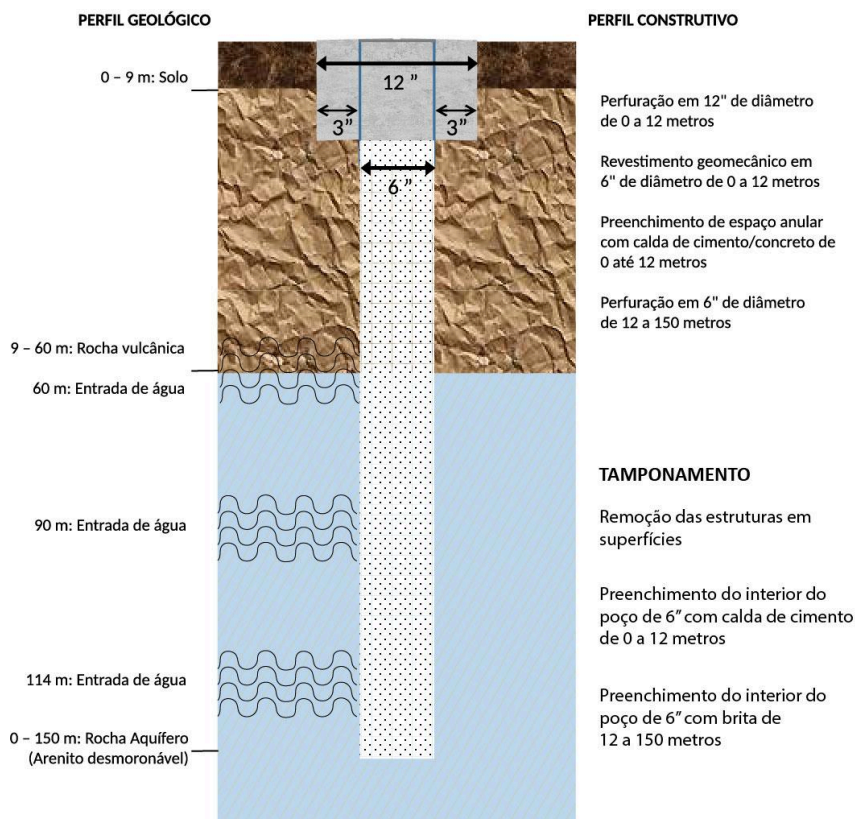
Perfil geológico-constructivo do poço tubular a ser tamponado para cumprimento da ETAPA 1.
